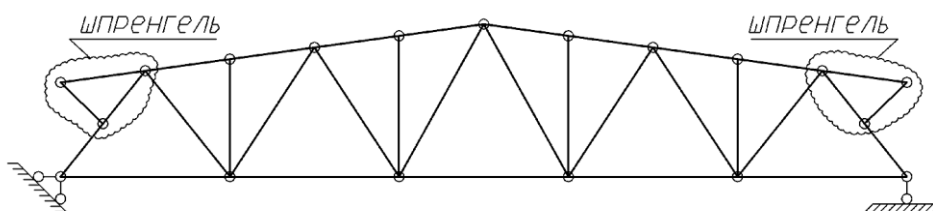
Вычисление шпренгелей из расчетной схемы исходной фермы.
